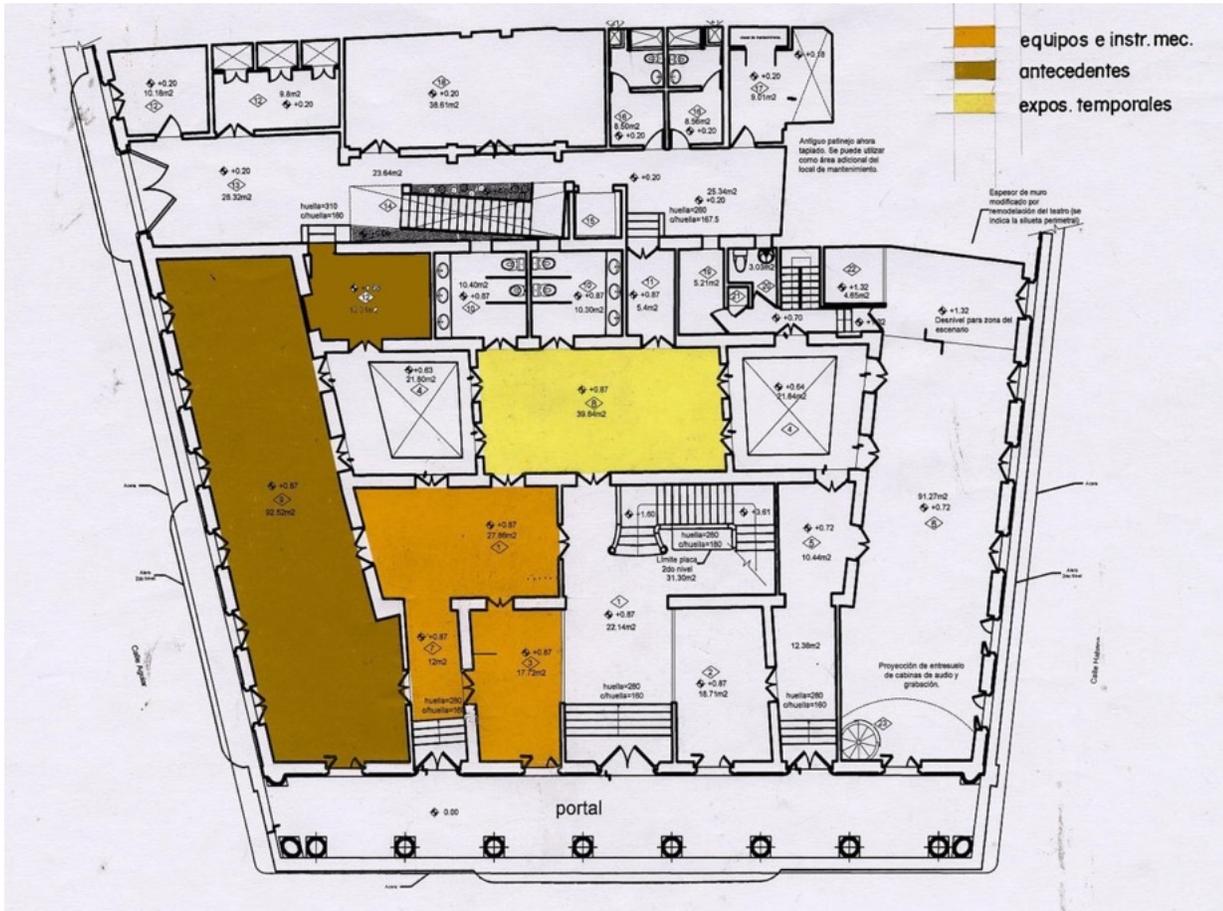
Distribución temática de las salas de la planta baja. Museo Nacional de la Música.
